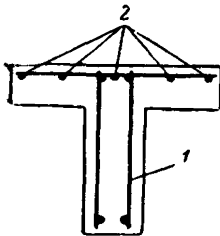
Армирование балок таврового сечения сварными каркасами и сетками
